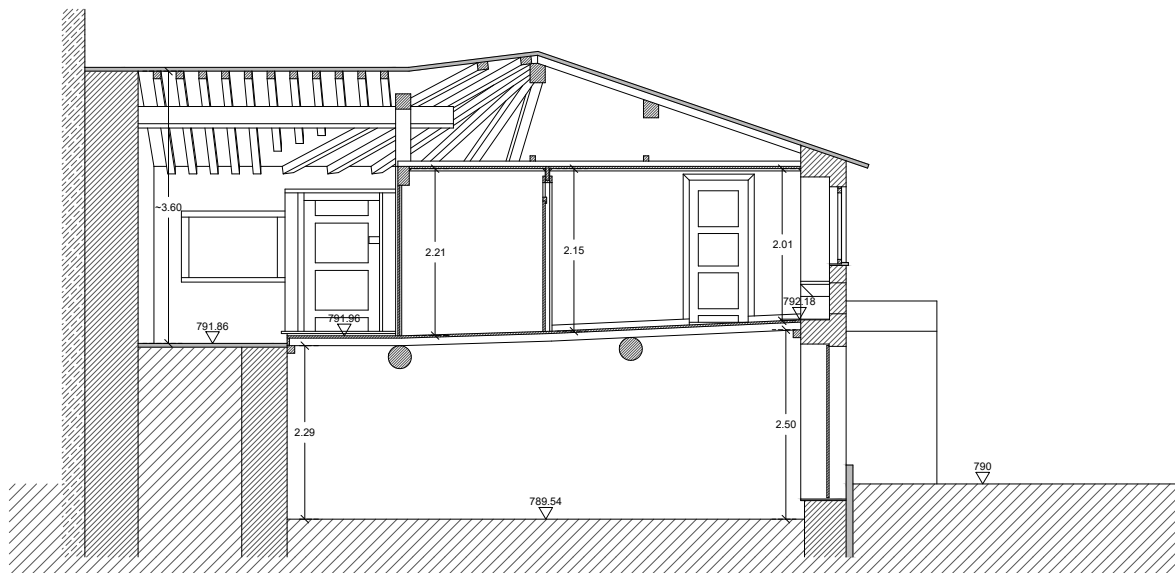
Corte 1 do levantamento. Escala 1:100.
